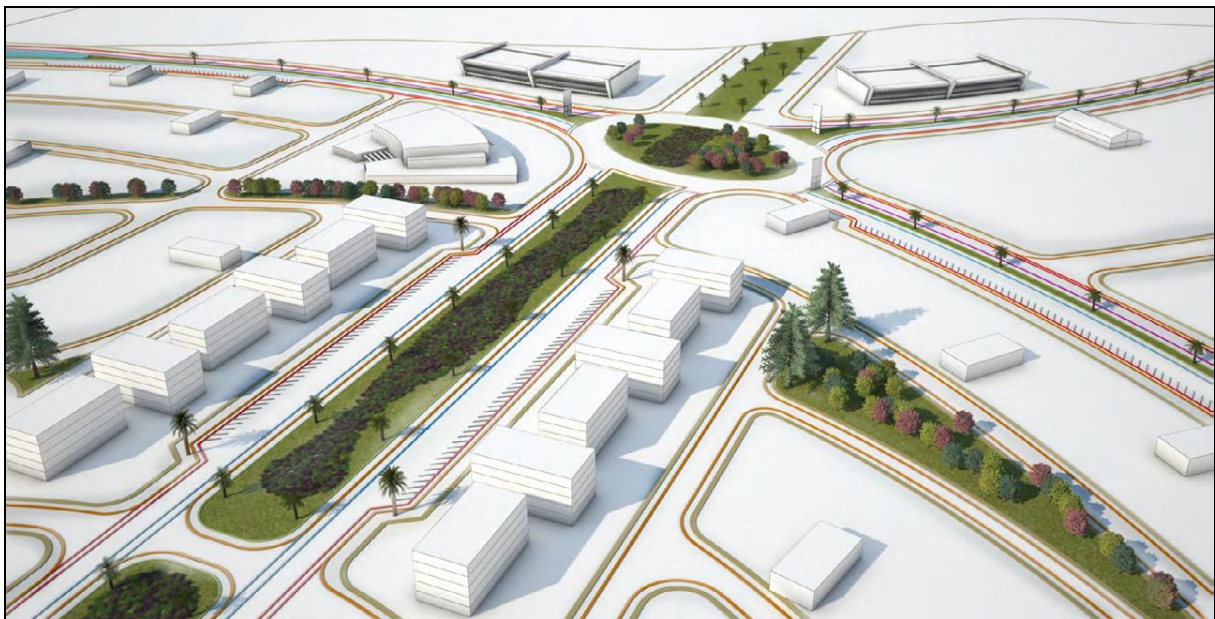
Vista 3D do empreendimento, ilustrando a disposição de áreas verdes em rótulas e canteiro central de avenidas.
